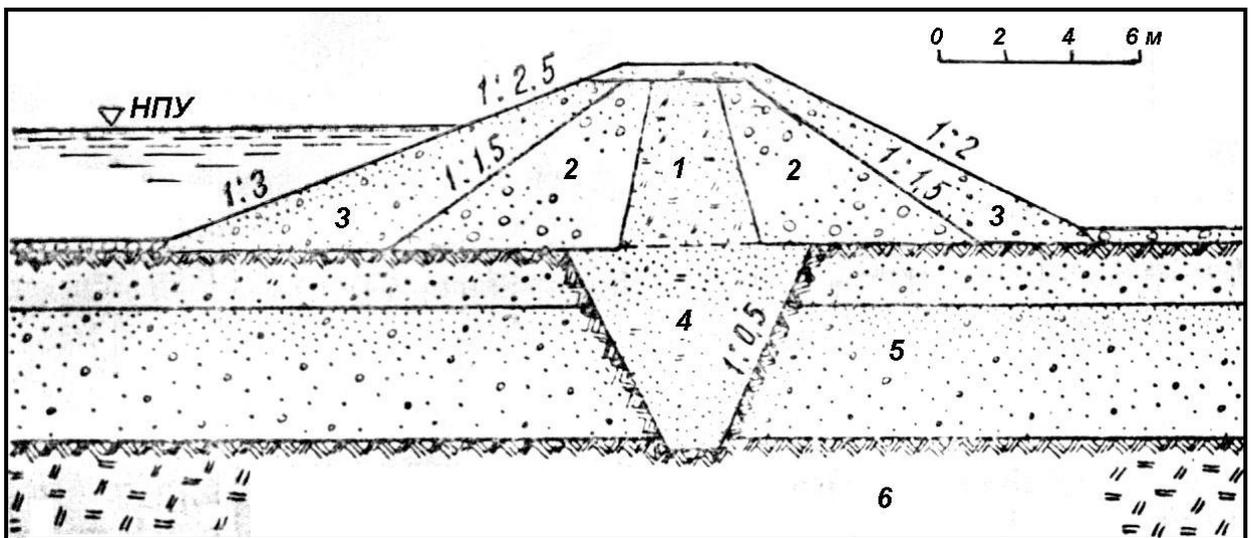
Земляная насыпная плотина Анадырского гидроузла на р. Казачке,
